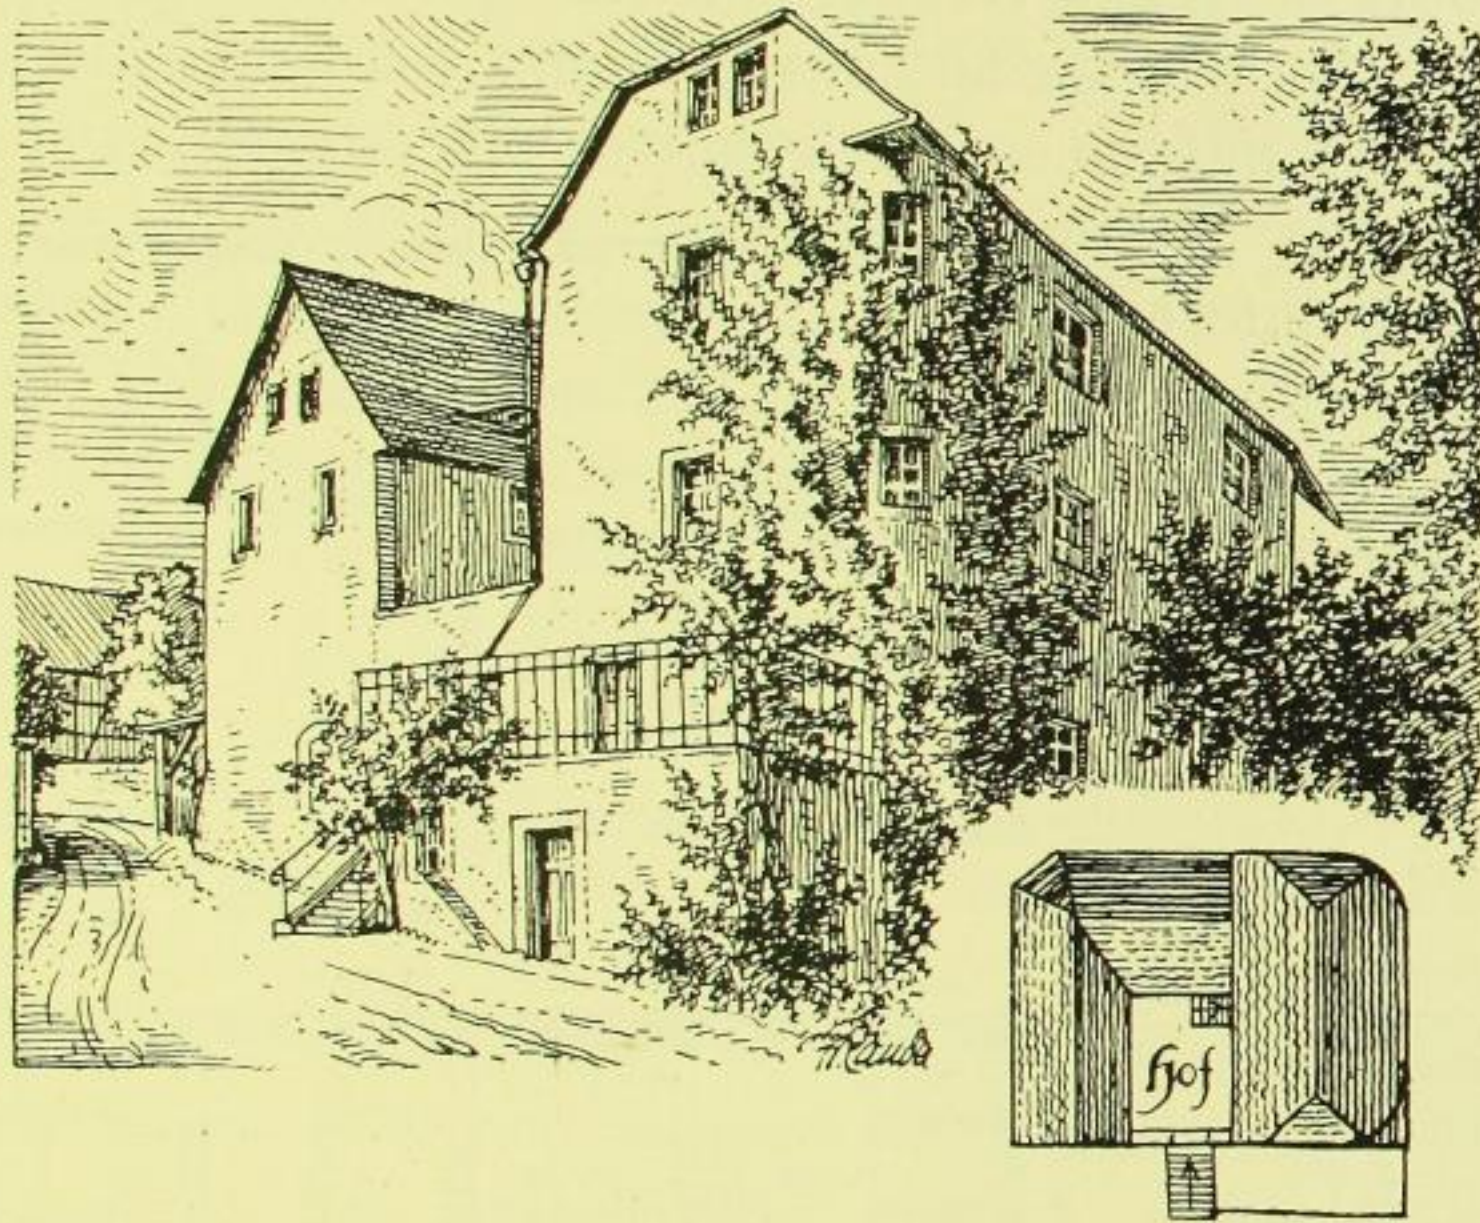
Burkhardswalde, Steingut, Ansicht und Grundriß.
